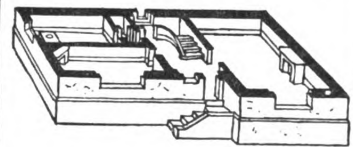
Comments s'explique le plan du rez-de-chaussée.
